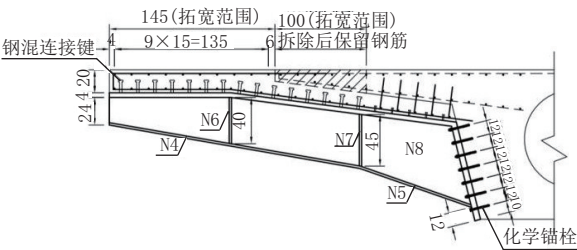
边翼缘横向工字钢组合结构拓宽标准断面布置(单位:cm)
